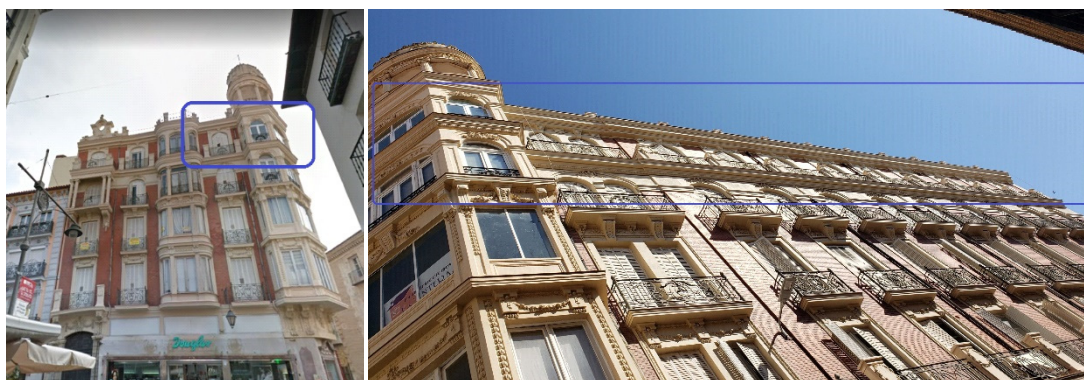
Fachadas Oeste y Sur de la Vivienda objeto de la rehabilitación EECN.
